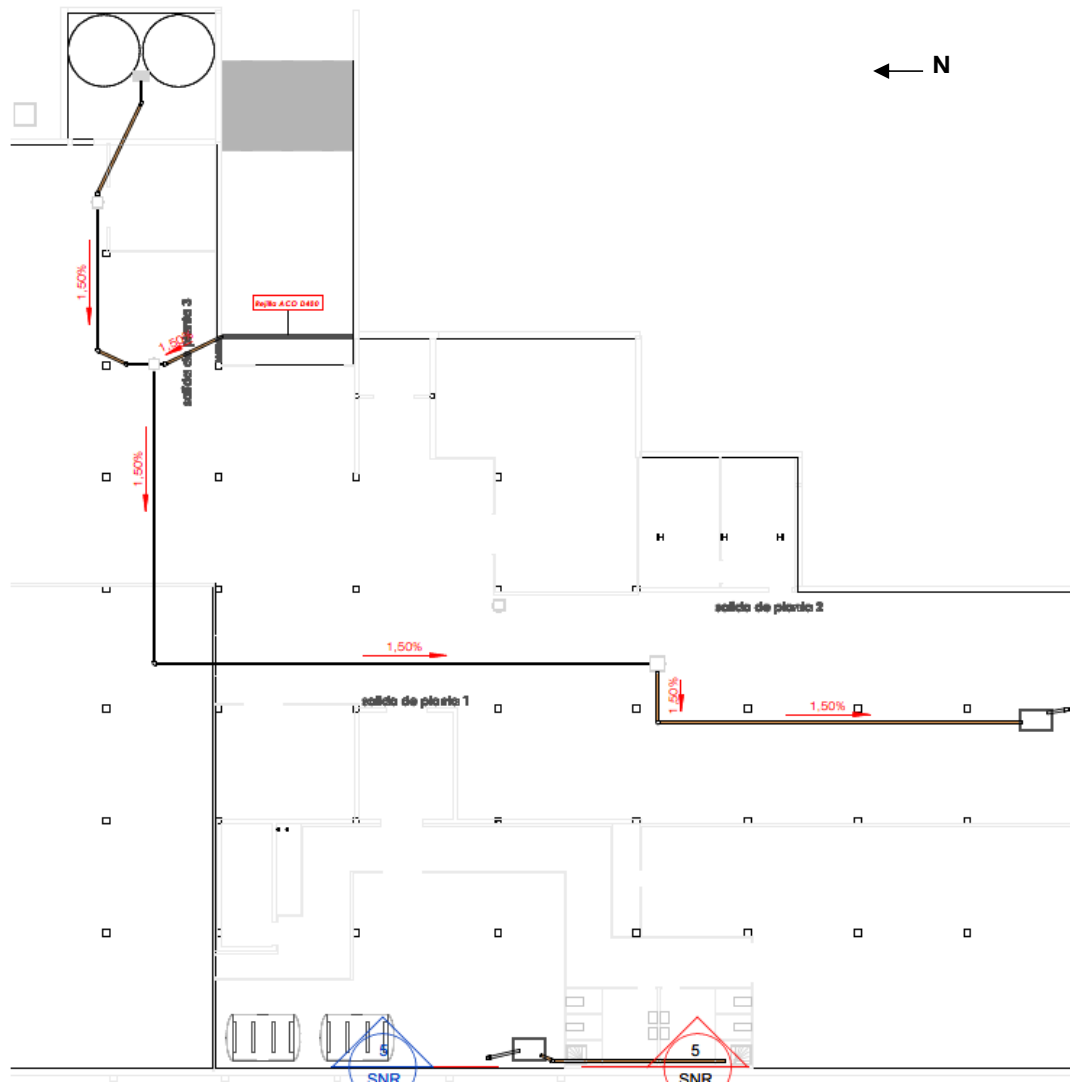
Red de saneamiento en la planta baja de la planta farmacéutica
